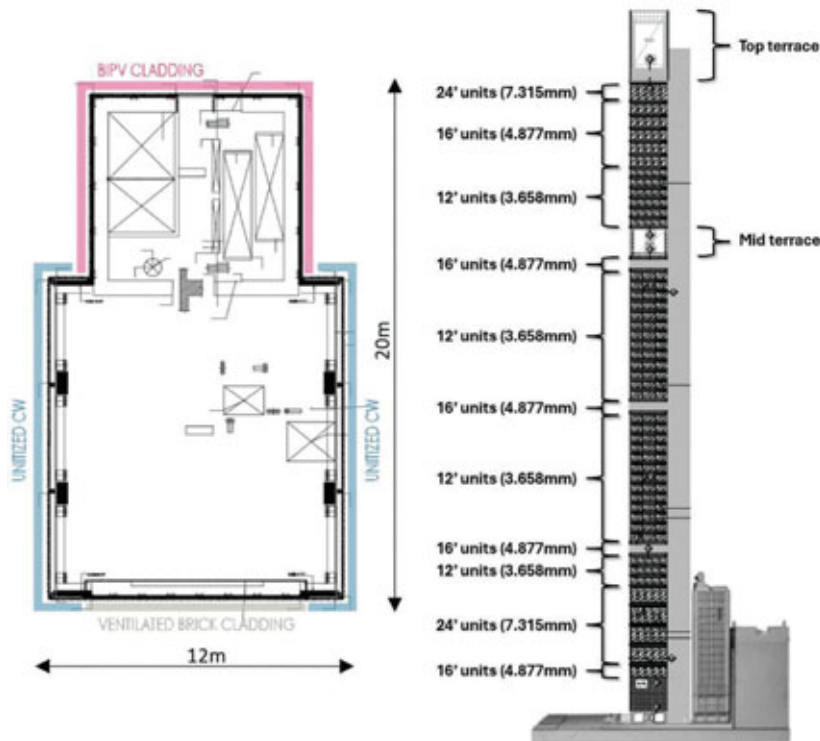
| Vista in pianta e prospetto della torre residenziale 262 5th Avenue
